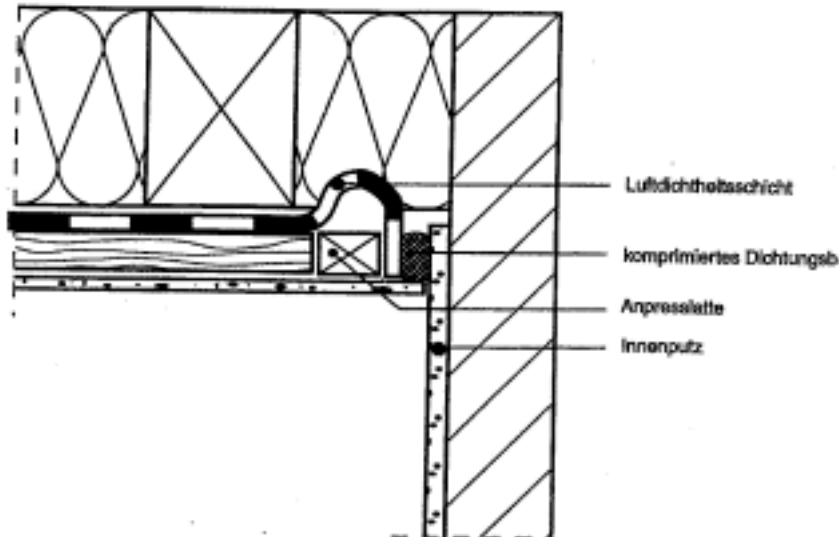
Prinzipdarstellung für einen Anschluss der Dichttheitschicht an aufgehendes Mauerwerk
